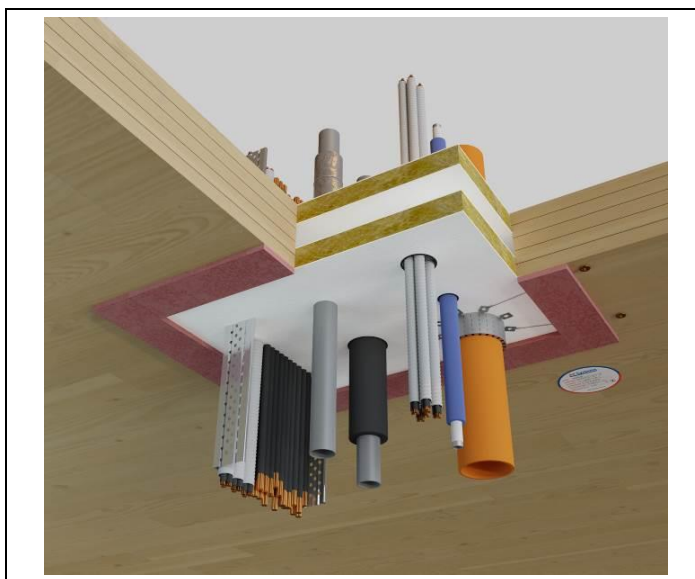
Exemple de joint AF PANEL dans un plancher en bois.
